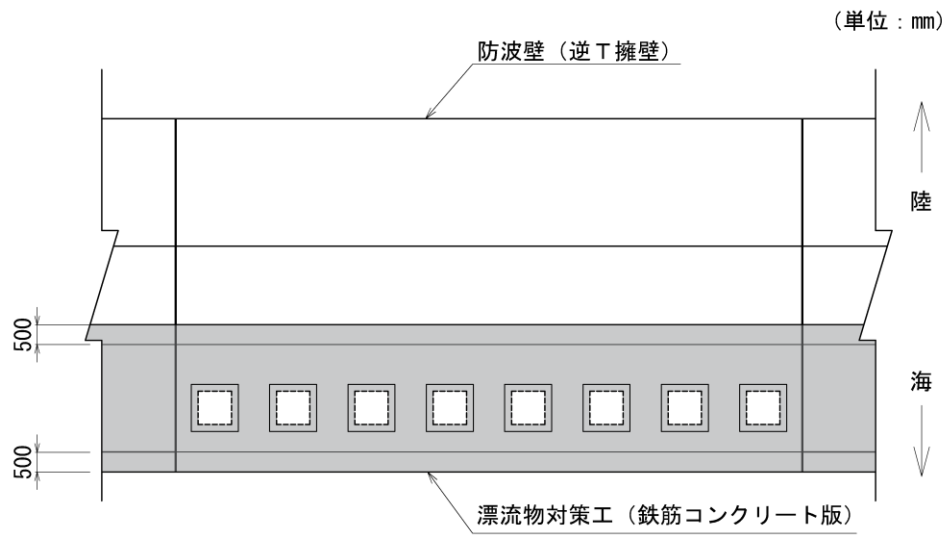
(1) 漂流物対策工 (鉄筋コンクリート版) の構造概要図 (平面図)
